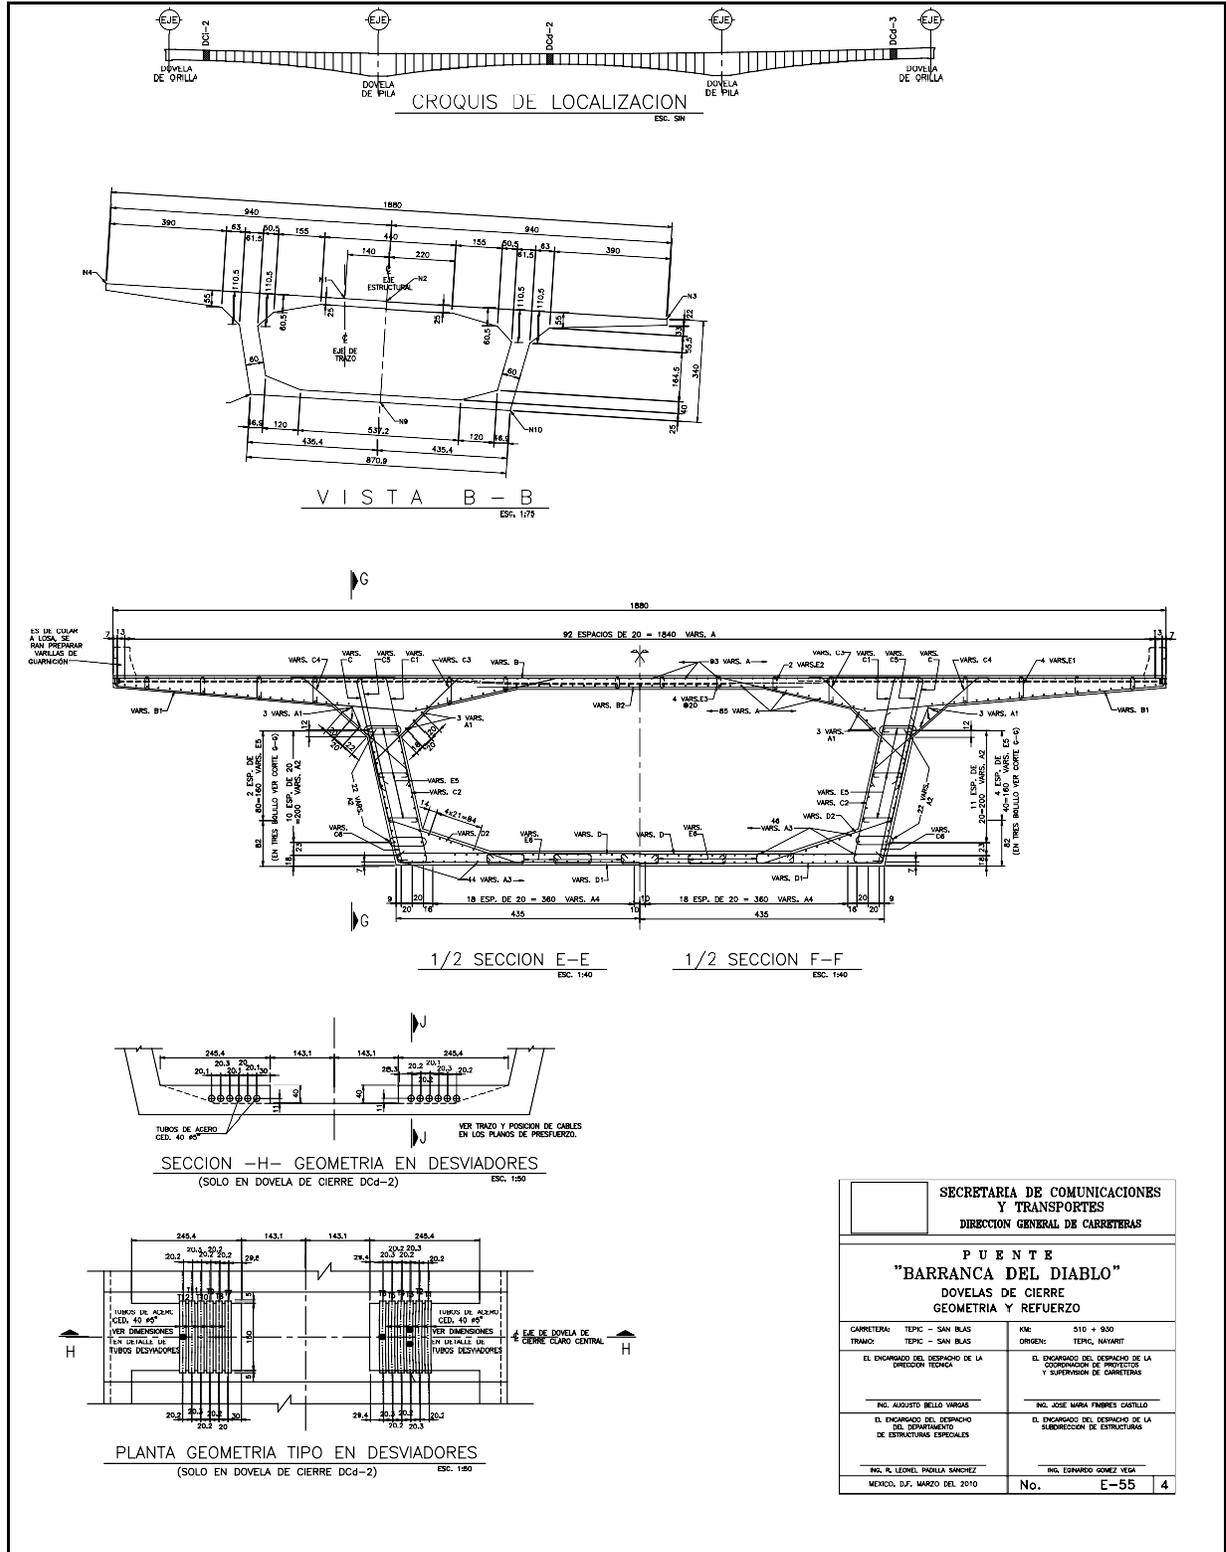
Detalles de los planos de las dovelas de cierre.
